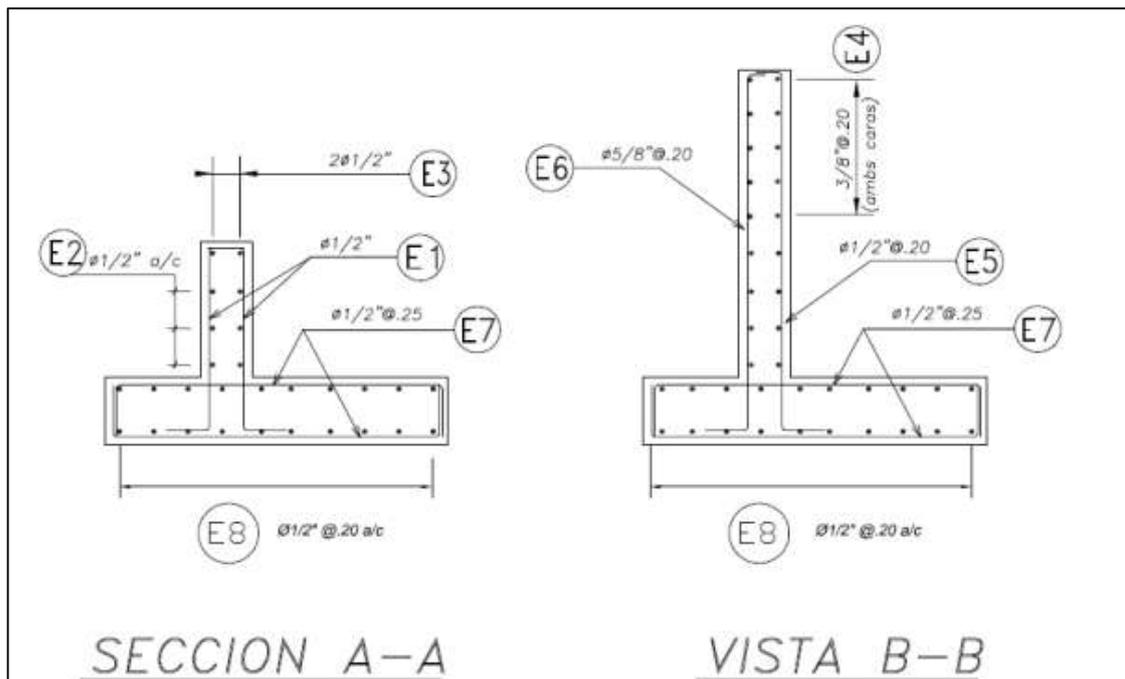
Detalle de acero en parapetos y muros contraimpacto
